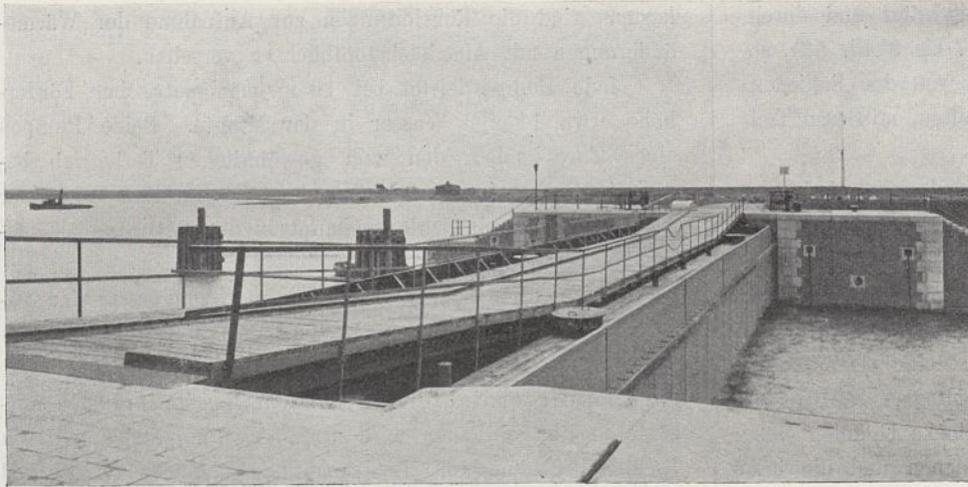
Schiebetor (geschlossen) mit Fahrbahn.
